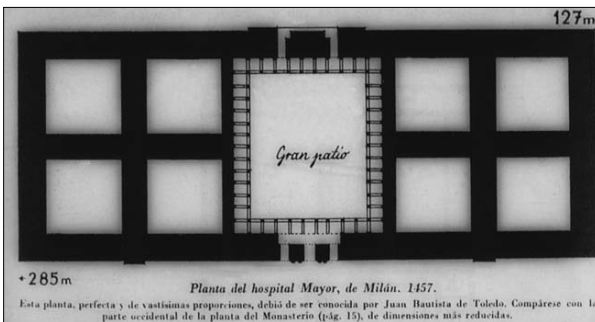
Planta del Hospital Mayor de Milán, 1457
